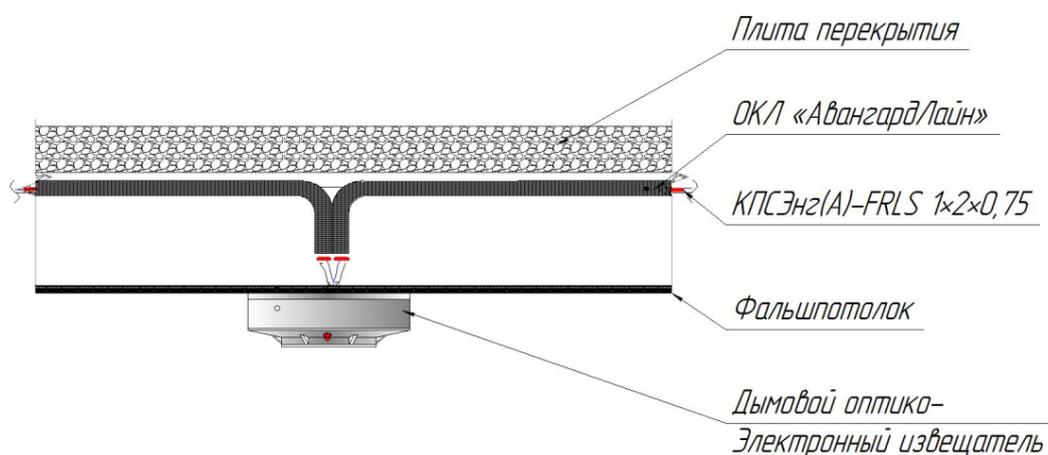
Схема монтажа оборудования АПС на потолке
